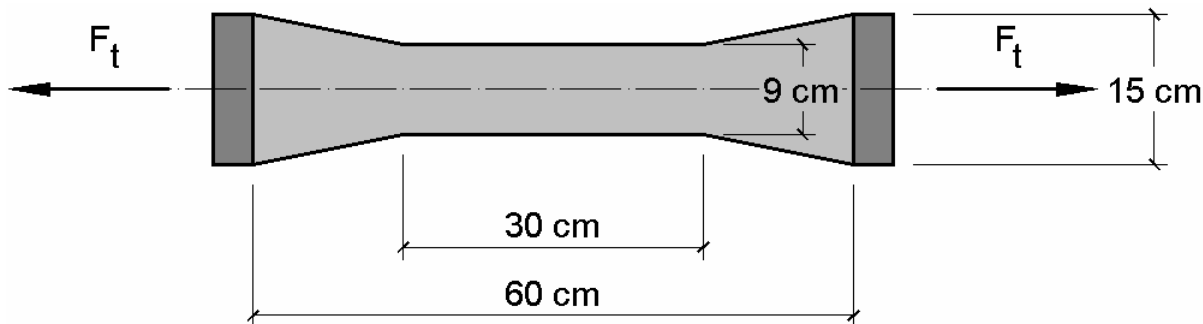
Esquema de rompimento de concreto por tração direta (FONTE: Estruturas de Concreto – Libânio Pinheiro)
